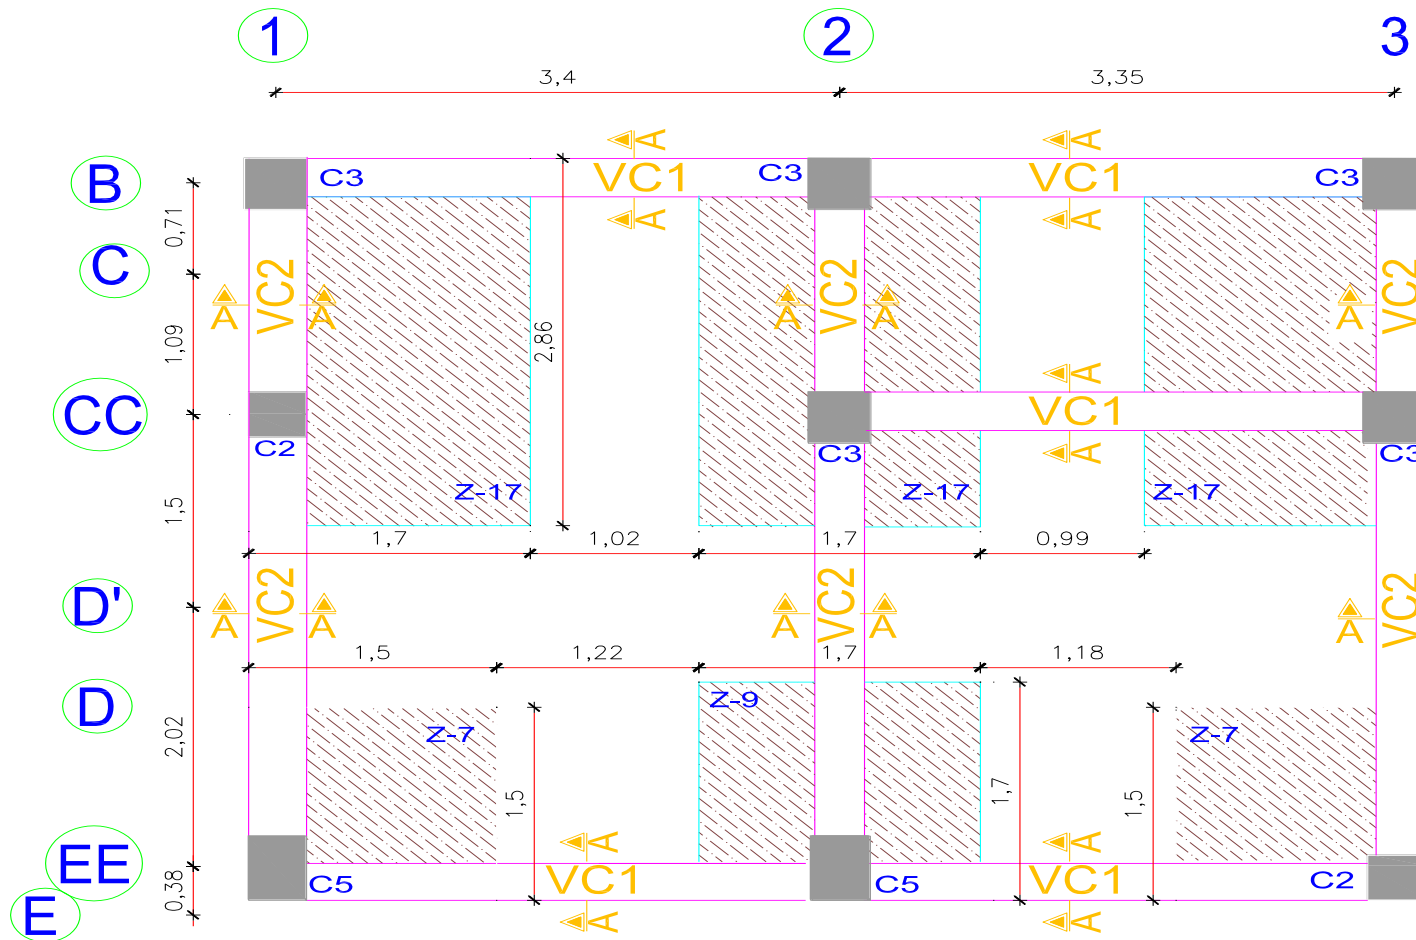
PLANTA DE ESTRUCTURA DE CIMENTACION BLOQUE 2.
